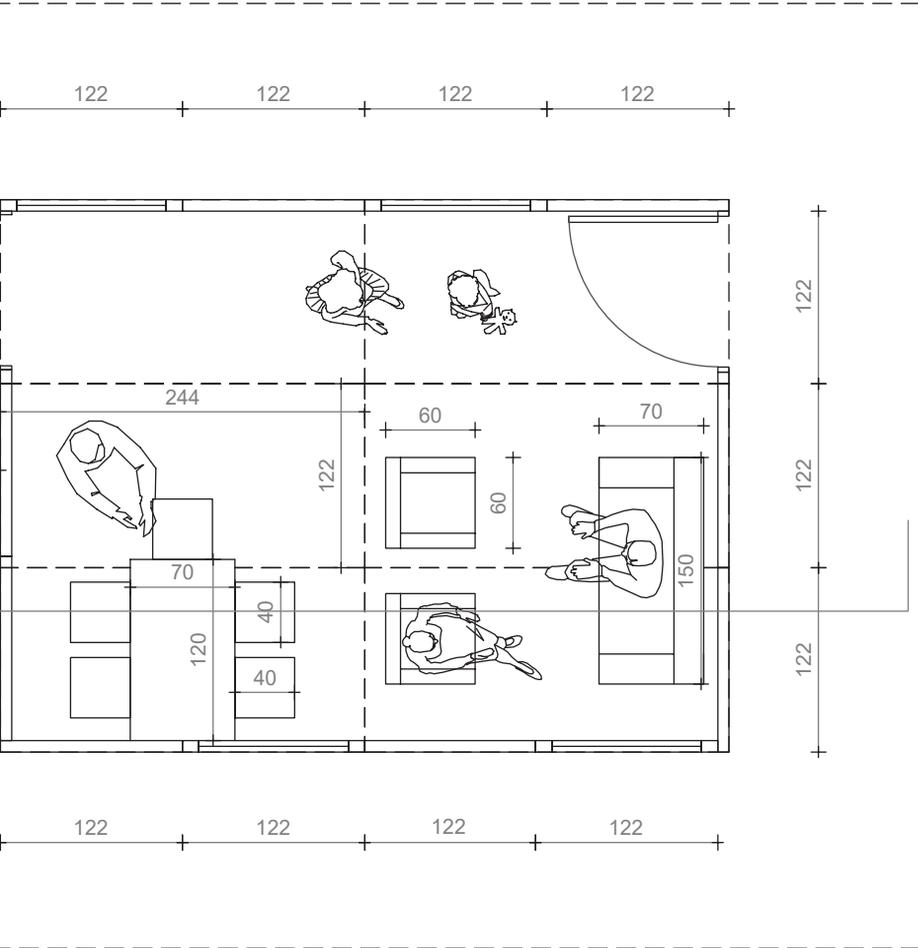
Elaboración propia. (2016). Planta de arquitectura del modelo norte.
